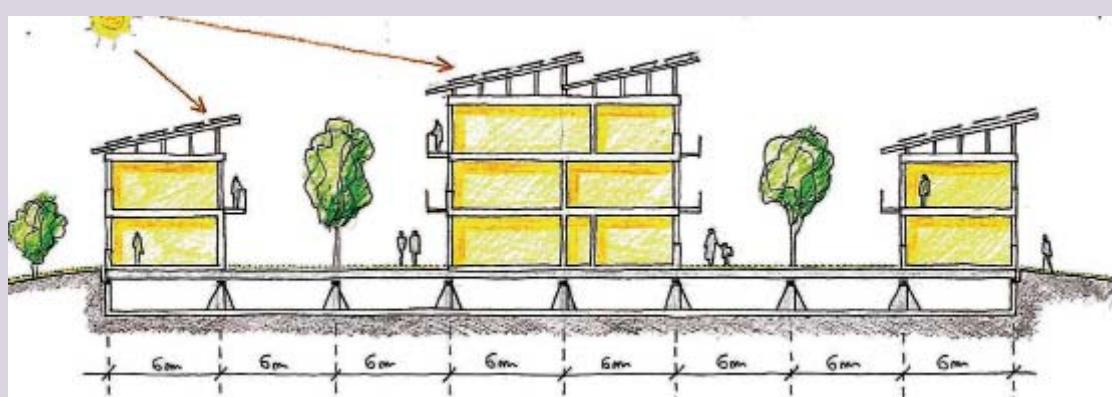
Общая схема городской застройки на основе опытных проектов домов с сейсмически изолированной плитой и внутренними пешеходными улицами. В конечном итоге было принято решение строить дома на индивидуальных сейсмостойких фундаментах⁸⁶.
